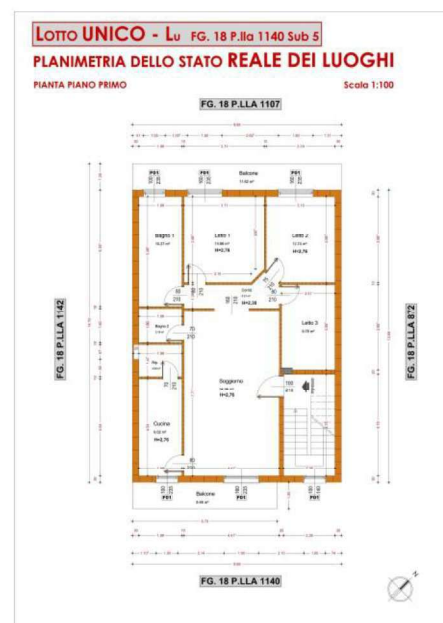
Planimetria dello STATO REALE LOTTO LU PIANO PRIMO (ALL. 07).
